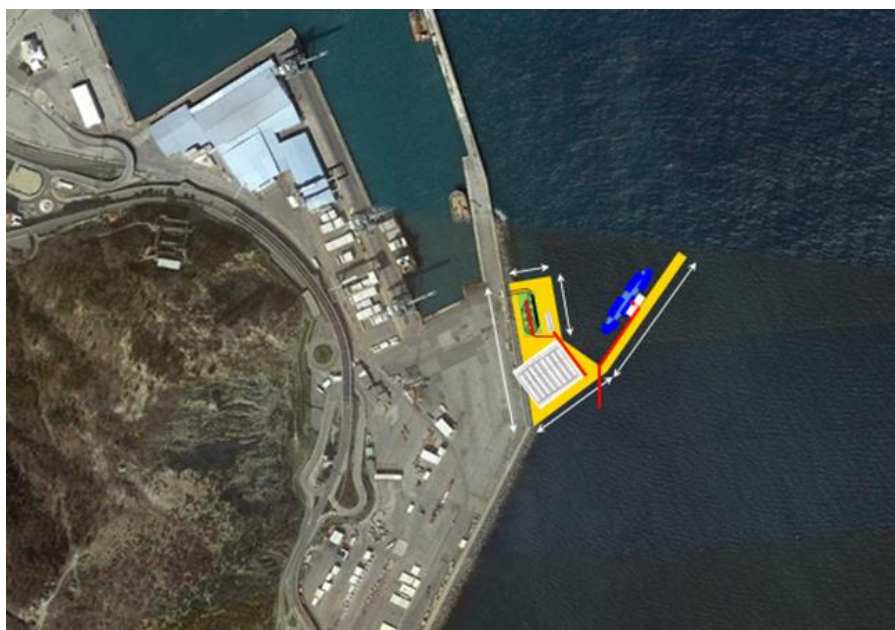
Layout ipotesi progettuale 3 (Fonte: Report “Deposito Small Scale LNG – Ipotesi preliminari” - 2018).
